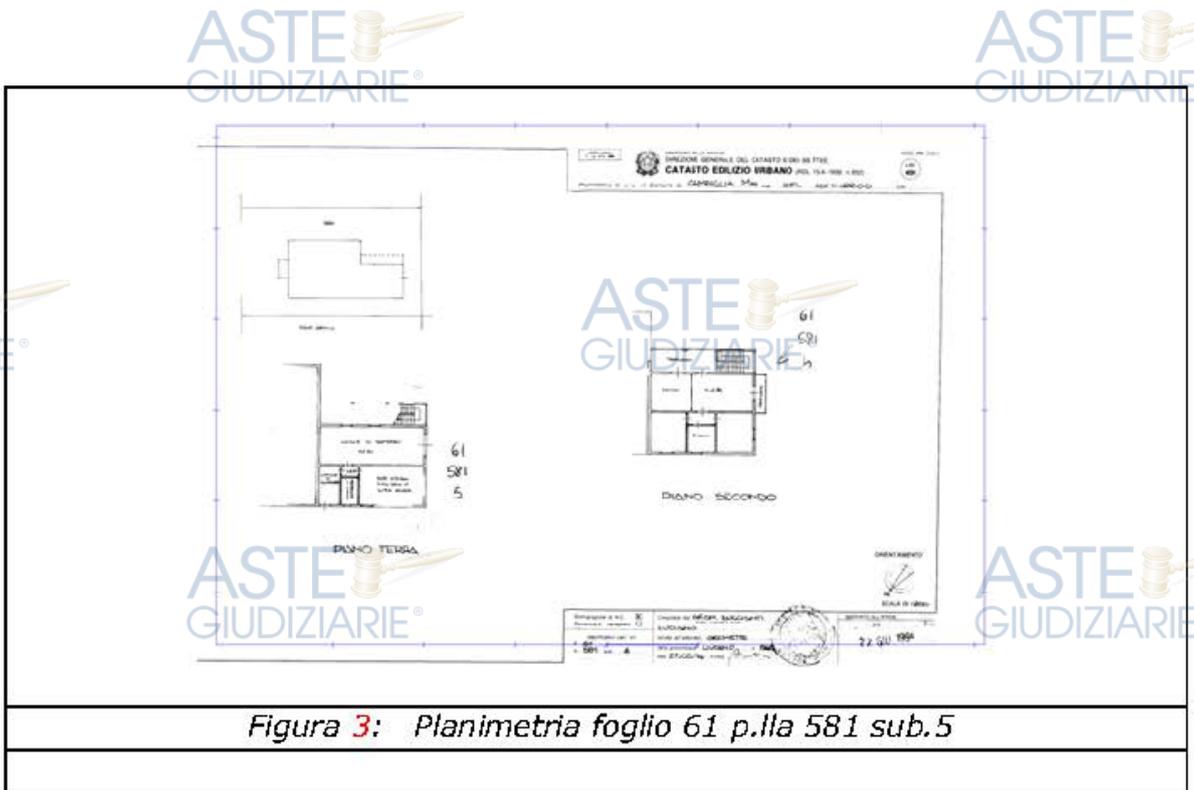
Planimetria foglio 61 p.lla 581 sub.5
